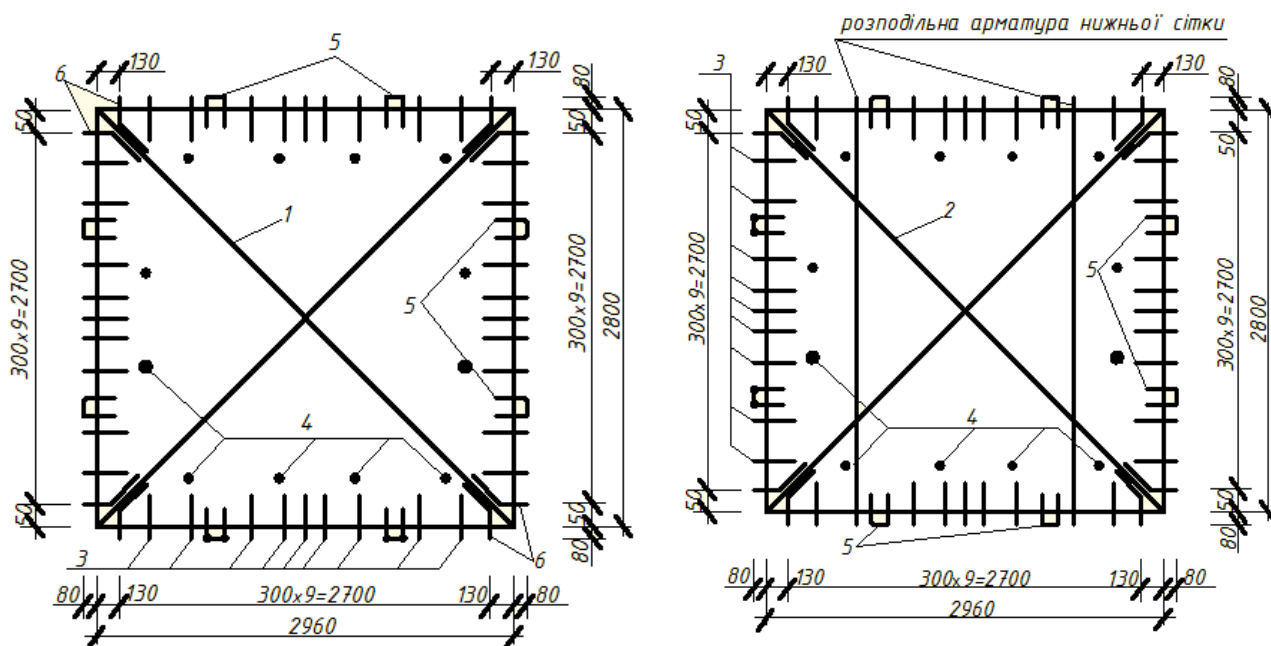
Опалубкове креслення та схема армування міжколонної плити ПМ 30.30.1,6-2-2б:
